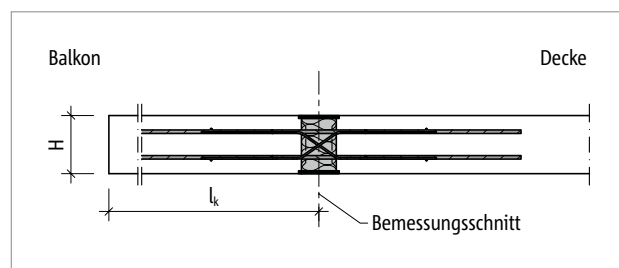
Schöck Isokorb® XT Typ DL: Statisches System
